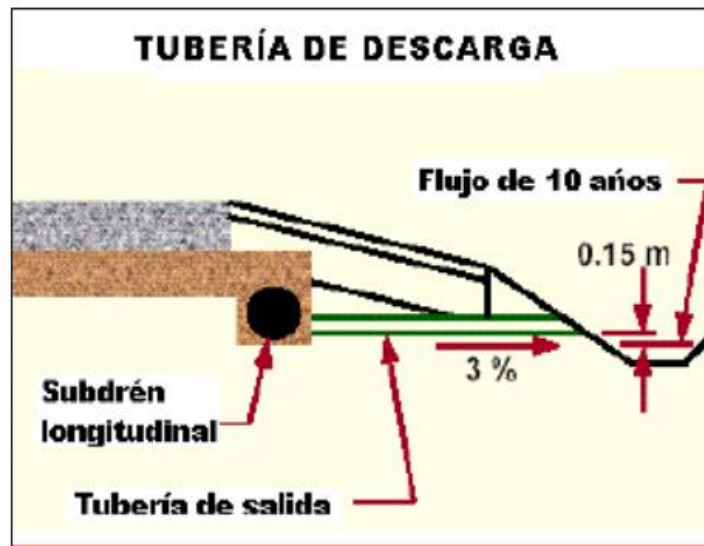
Esquema general de una tubería de descarga (Consideraciones sobre drenaje en pavimentos, 2014).
